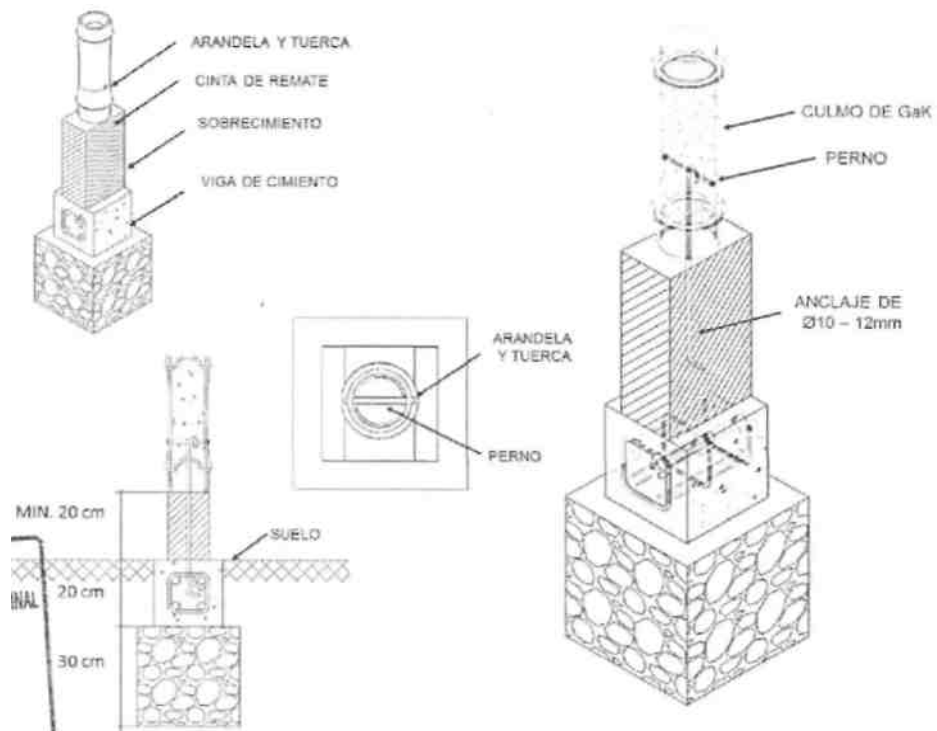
Detalle de apoyo de columnas de GaK en sobrecimiento
